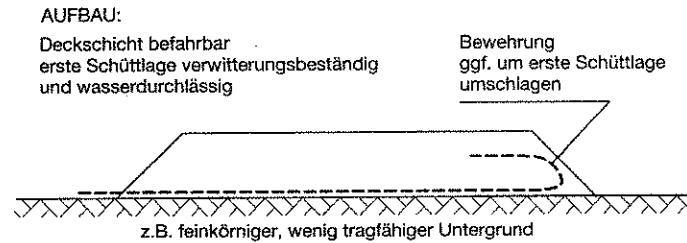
Bewehrungslage unter Straßen mit ungebundenem Oberbau (Baustraße, Wirtschaftsweg) [8]
